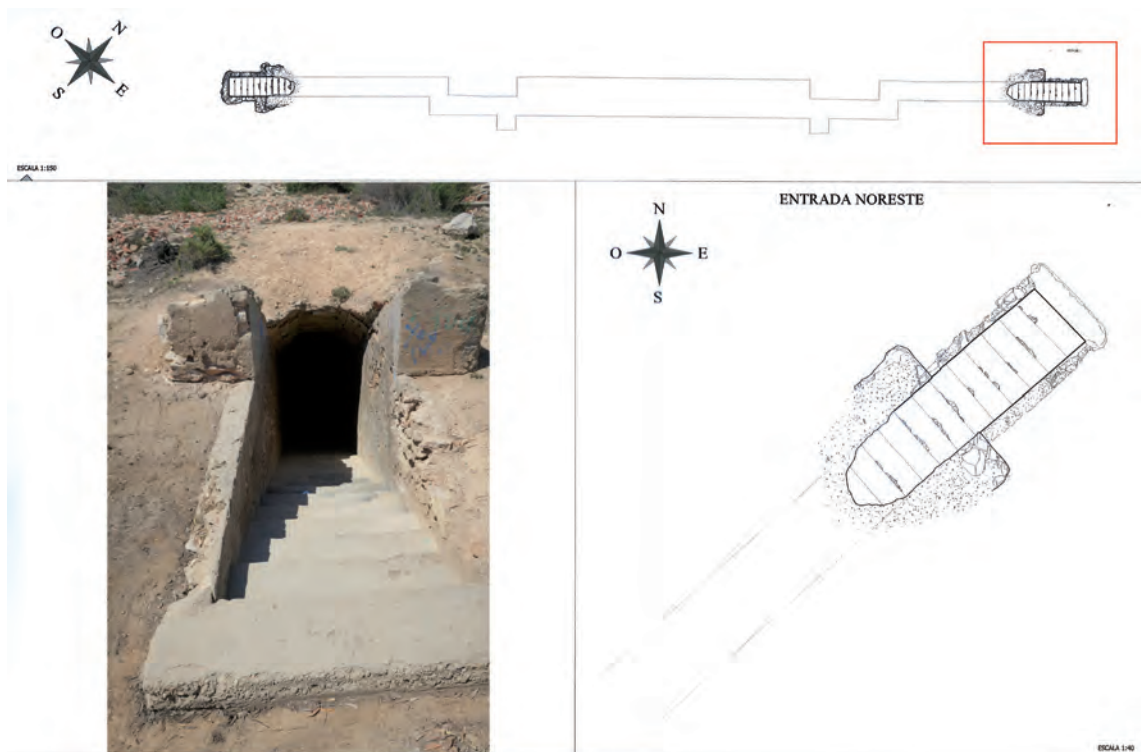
Planta del refugio y entrada noreste (Foto Alebus).
